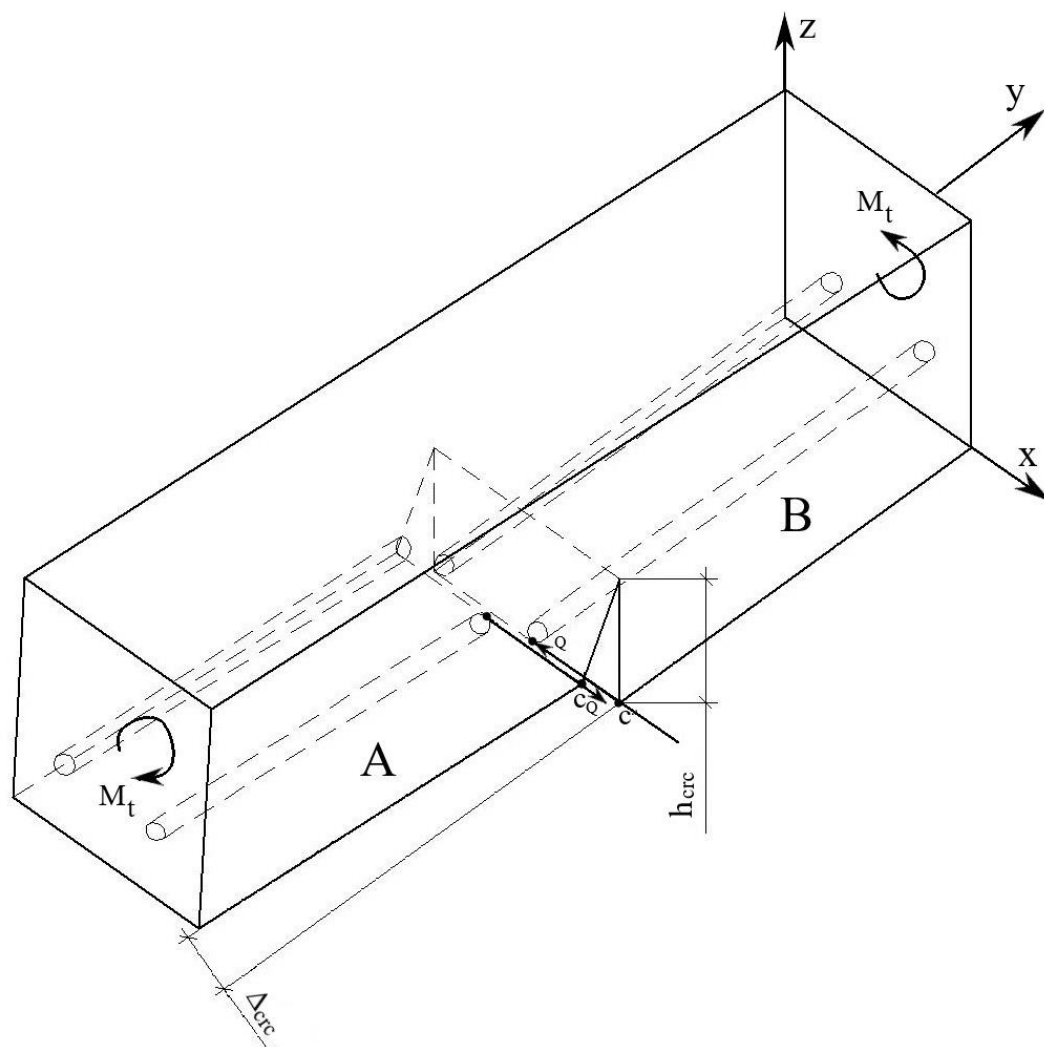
Схема для определения нагельной силы в арматуре при взаимном повороте двух блоков, отделенных трещиной
